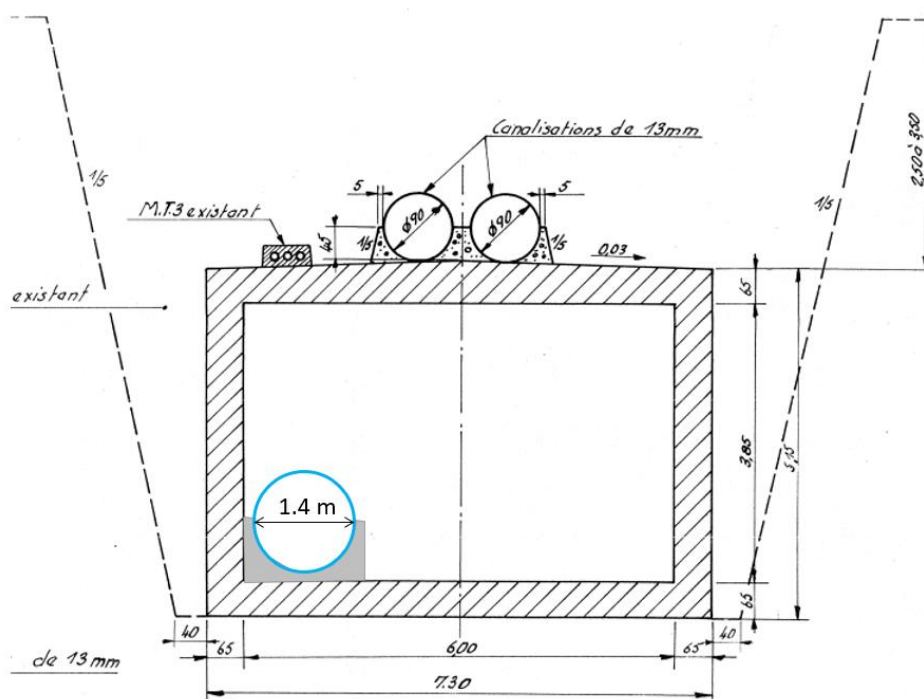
Encombrement d'une conduite Ø1400 mm dans la galerie de l'évacuateur 6 m x 3.85 m
